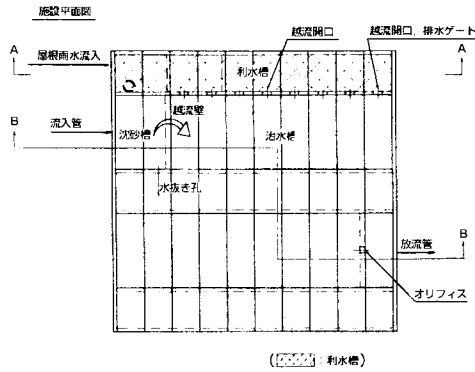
屋根雨水の簡易ろ過貯留施設の構造概要図
